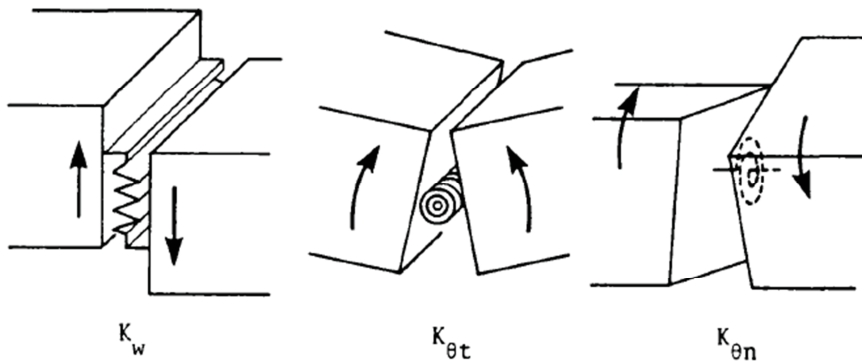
Modellazione di giunti di pavimentazioni ad elementi autobloccanti in calcestruzzo [4].
